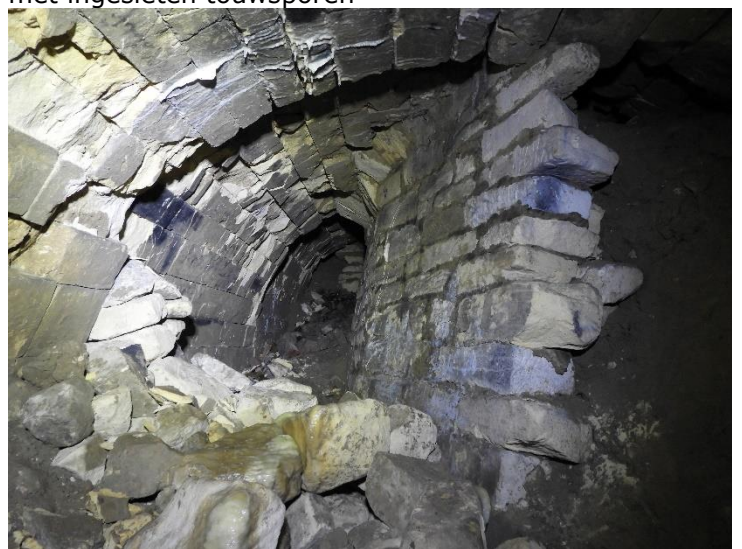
Toegangstunnel Stadtberg I, verstevigd met stenen
